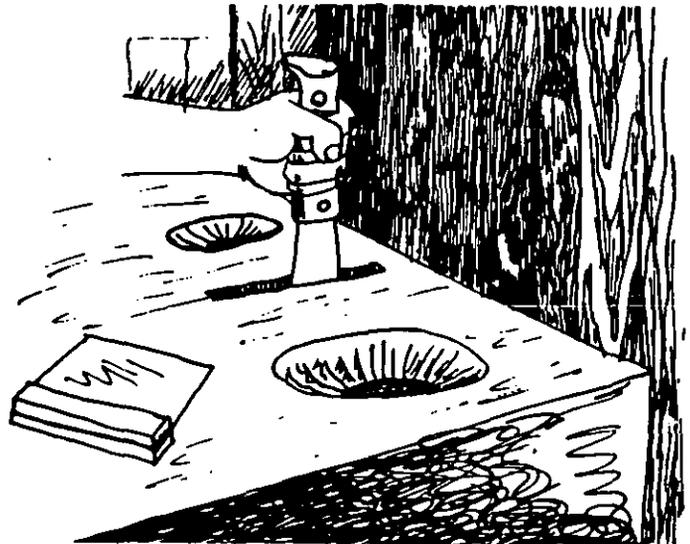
Corte de la ranura para colocación de las puertas de la hornilla.
